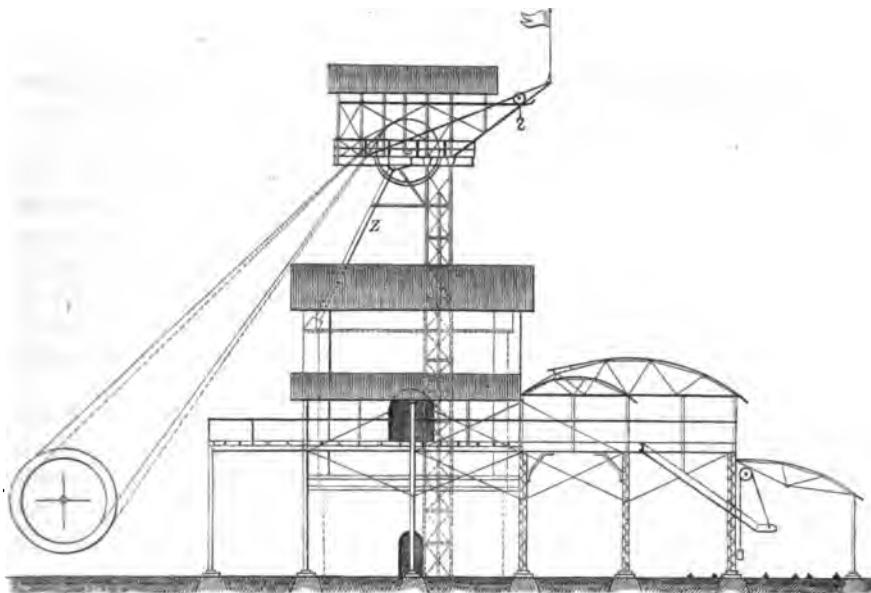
Fördergerüst nebst Ladebühne der Zechen Rheinelbe und Alma bei Gelsenkirchen.
